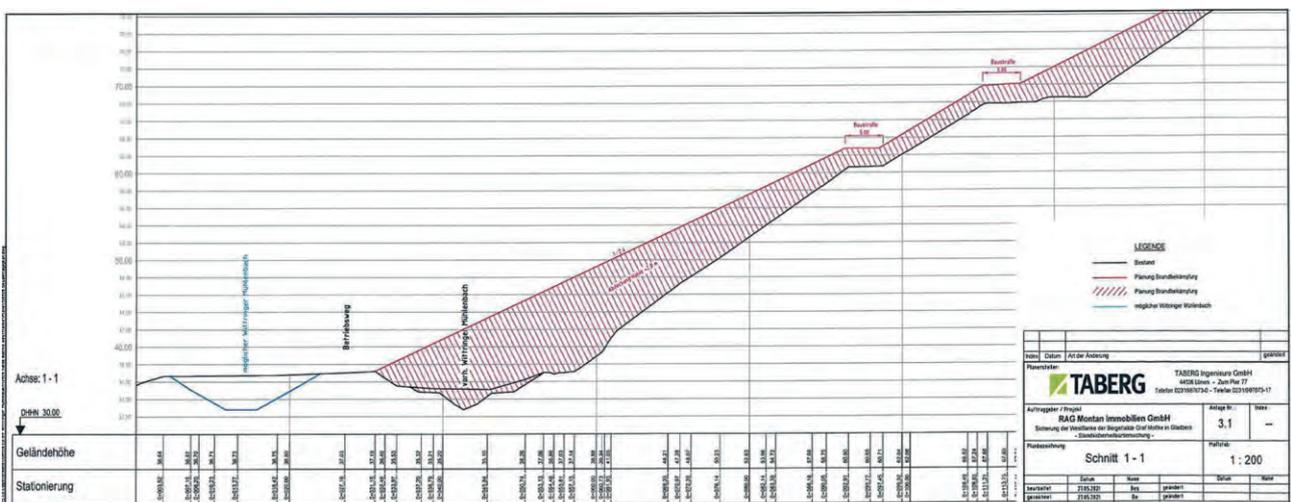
Geplante Übererdung mit Lage Mühlenbach
